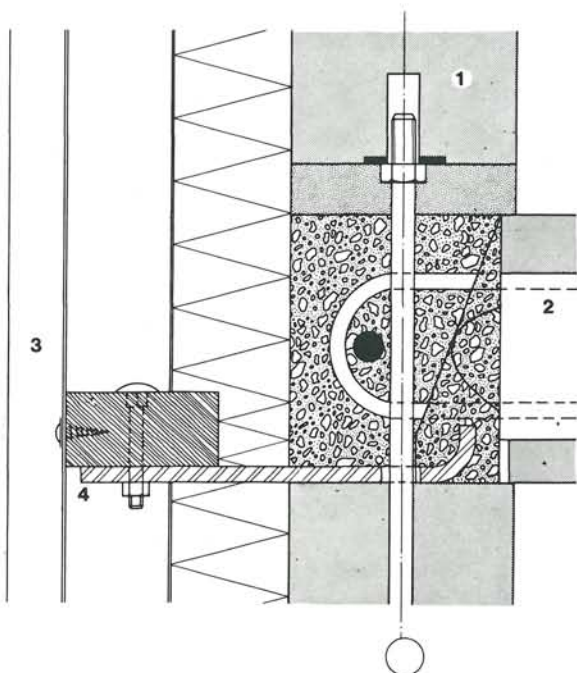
Sección vertical de la unión muro-losa de forjado.
